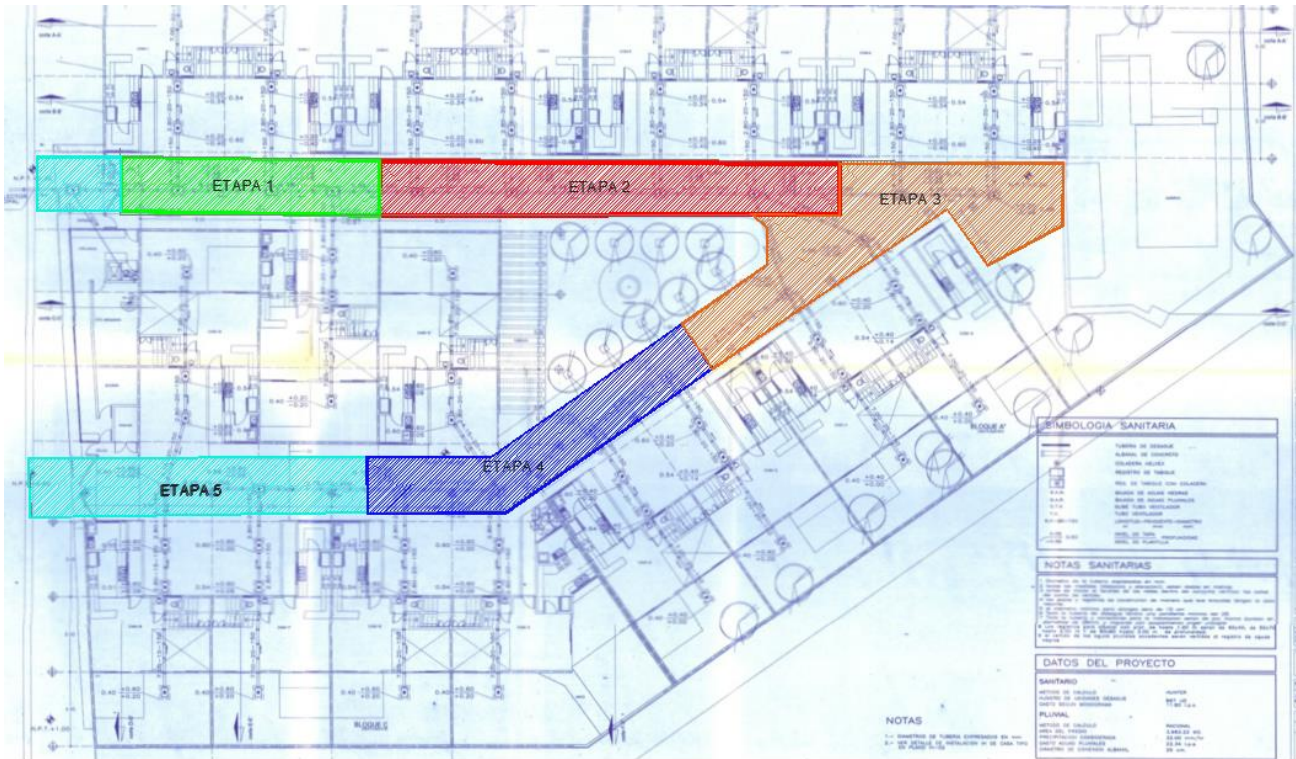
Plano de conjunto para programar las etapas de trabajo para tener la menor afectación. Autoría propia.
